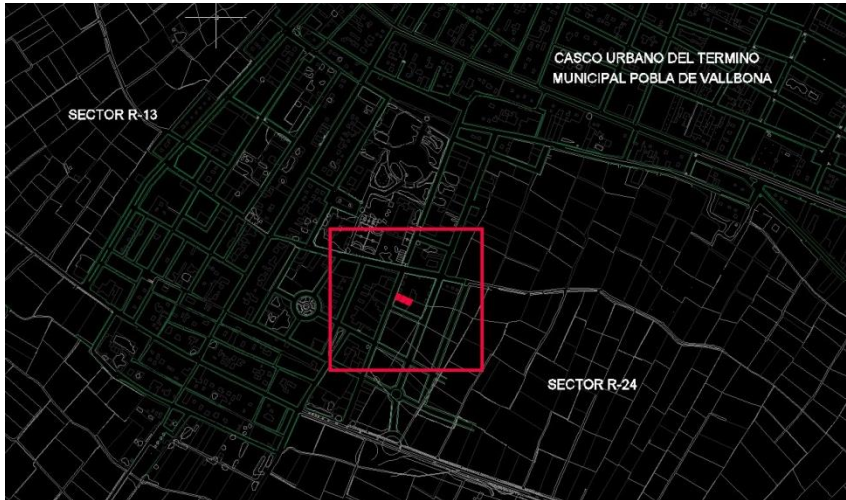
PLANO DE EMPLAZAMIENTO.
